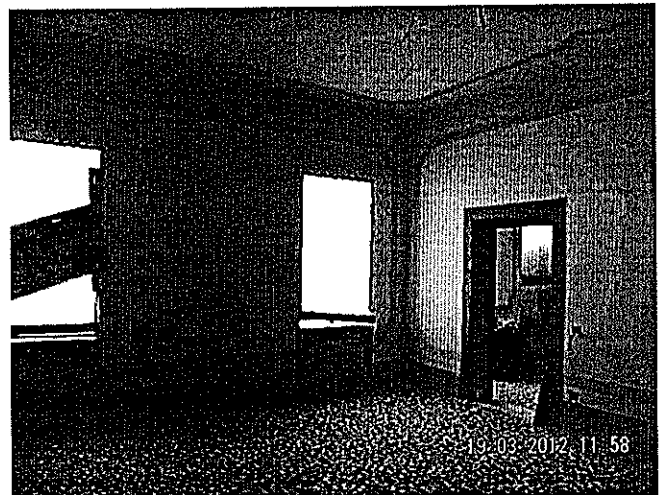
Stanza 1.8 Parete lato strada e porta sala
